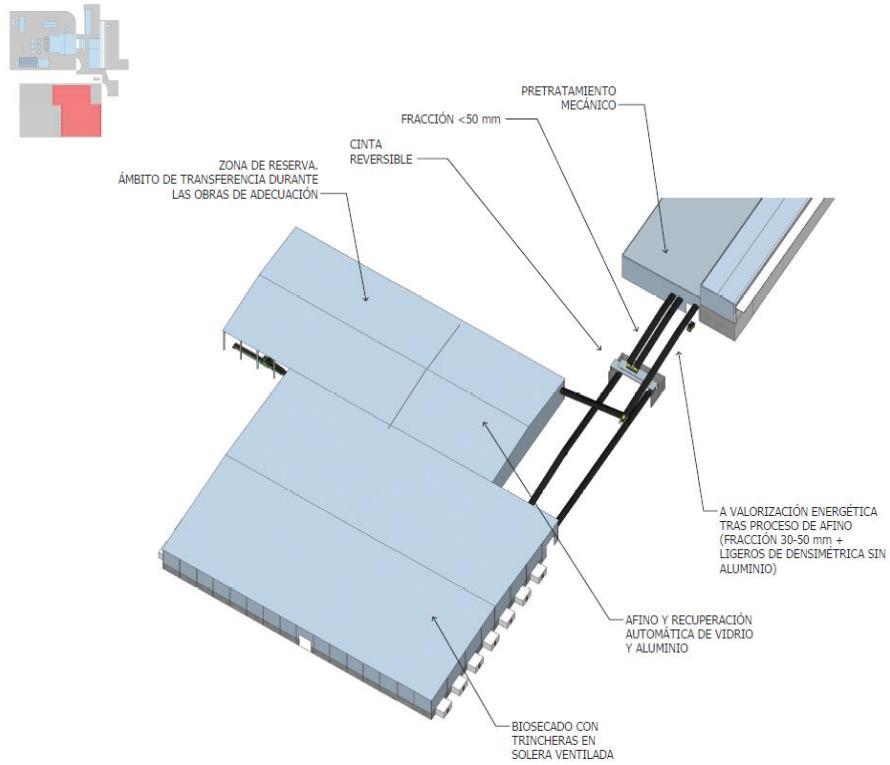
Planos de la planta de biosecado y afino: zonas de operación
